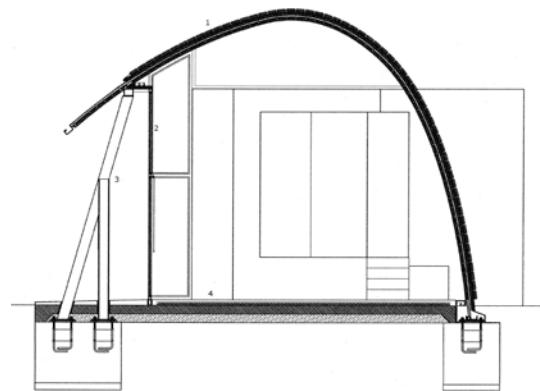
Corte detalhe da casa Mingo. (*-16).
